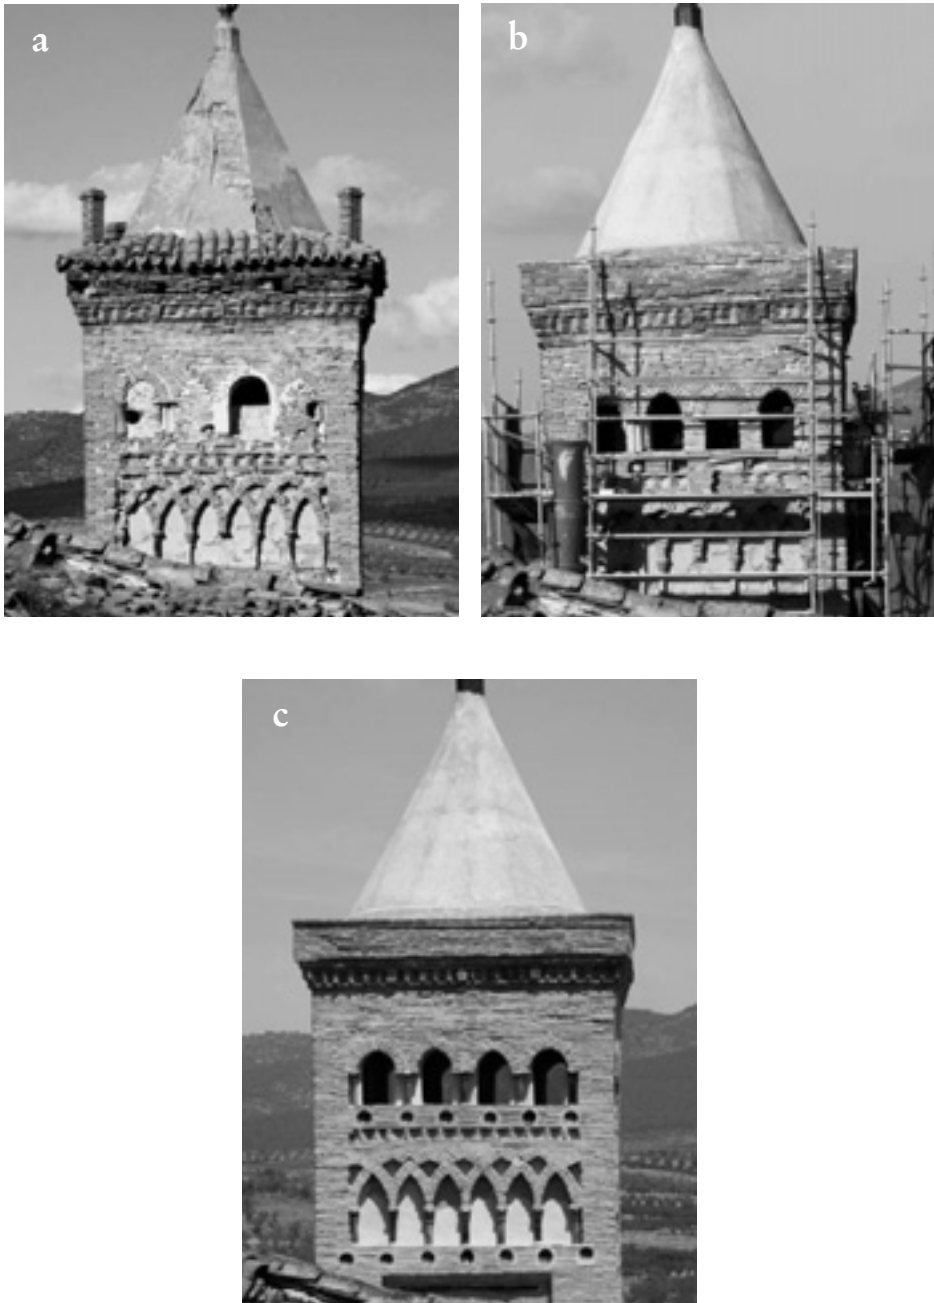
Secuencia de imágenes de la fachada suroeste: a) en 2004, en su estado inicial; b) en 2006, tras la primera fase de las obras de consolidación estructural; c) en 2008, concluida la restauración del cuerpo superior.
